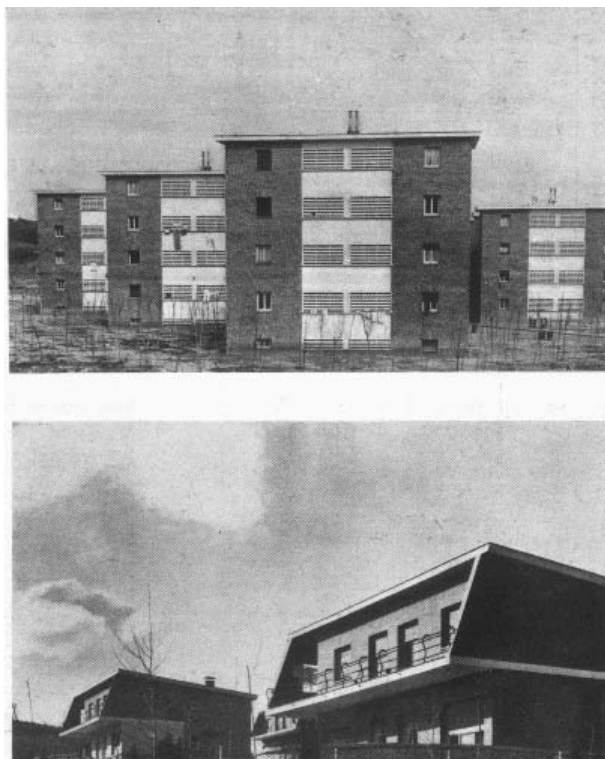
Viviendas construidas. Fuente: Revista Nacional de Arquitectura
